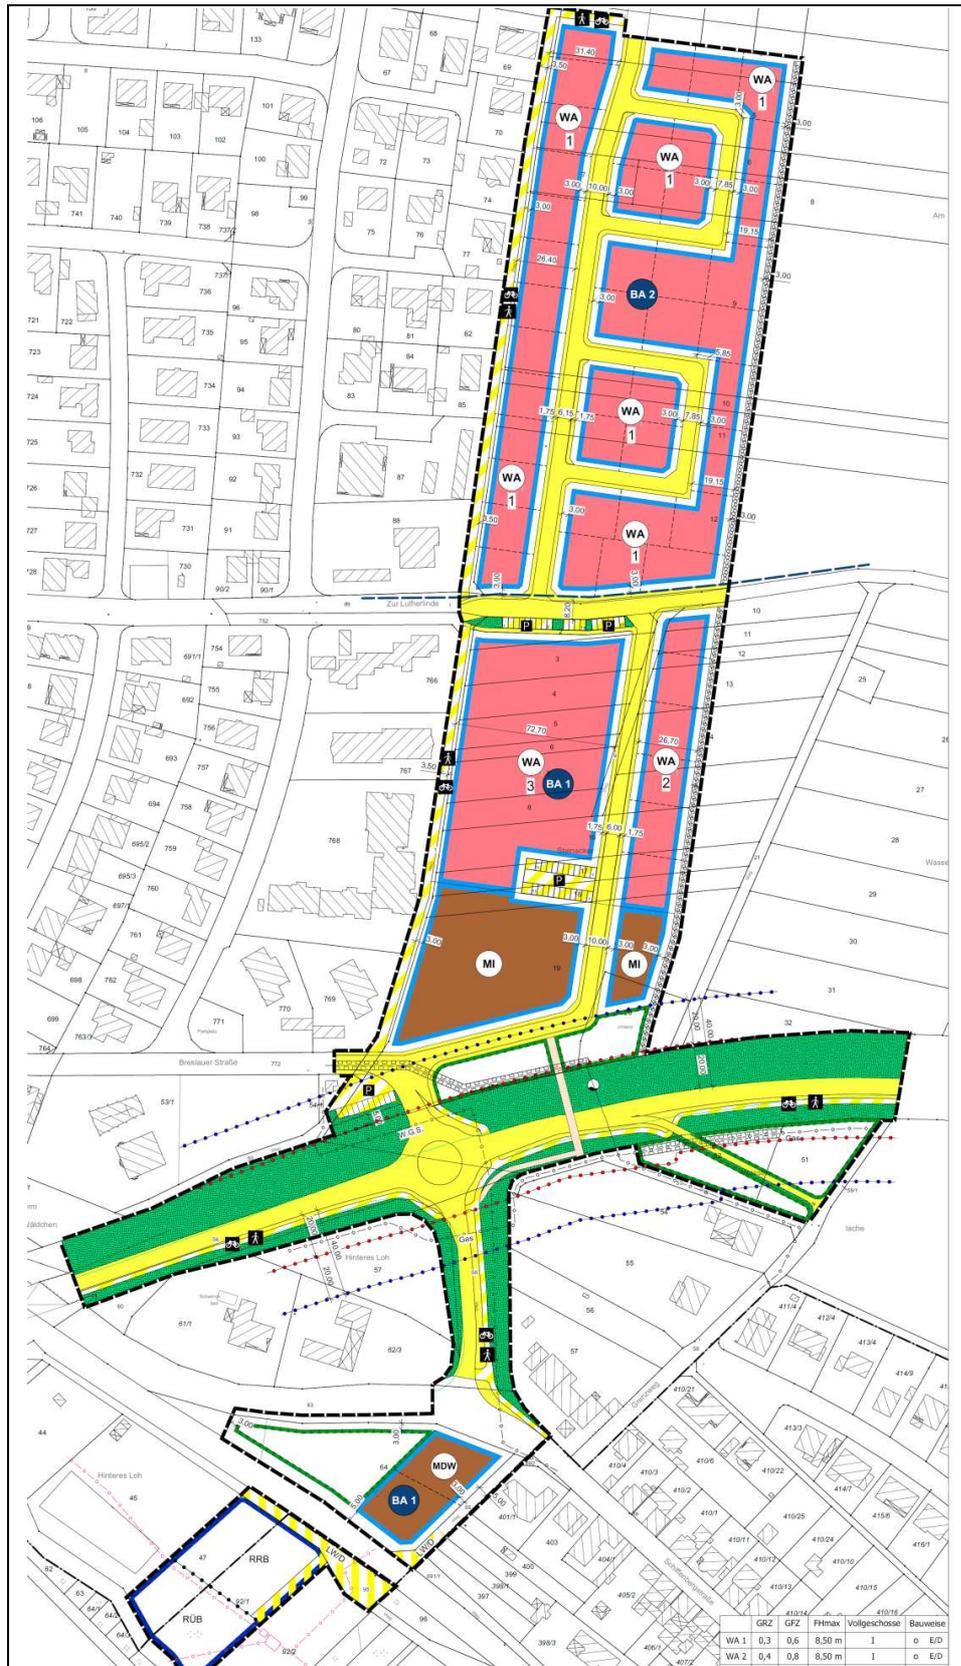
Vorentwurf Bebauungsplan Nr.15 "Hausen-Ost Süd" (Auszug).
